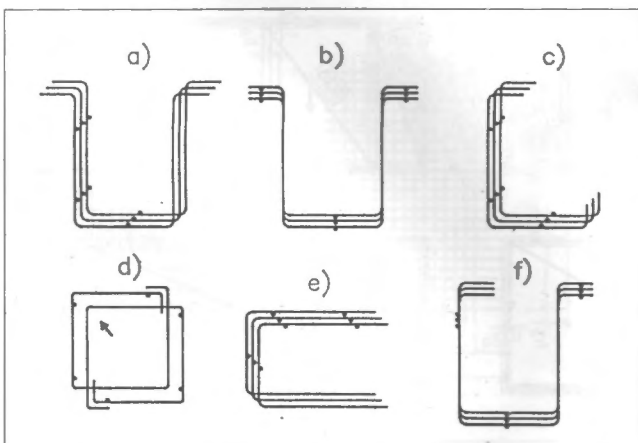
Spodní výztuž desky pomocí jednosměrných sítí
